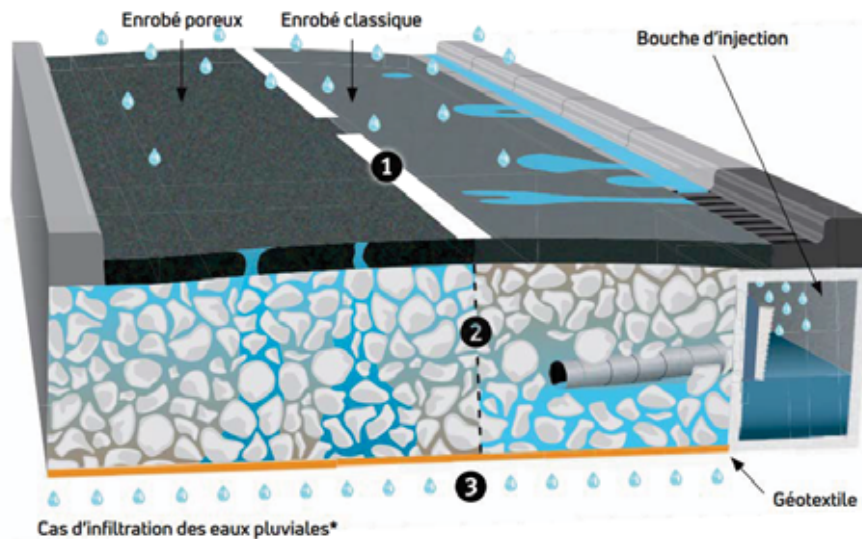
Schéma d'une chaussée à structure réservoir avec enrobé poreux (à gauche) et enrobé classique (à droite) dans le cas d'infiltration des eaux pluviales – ADOPTA
